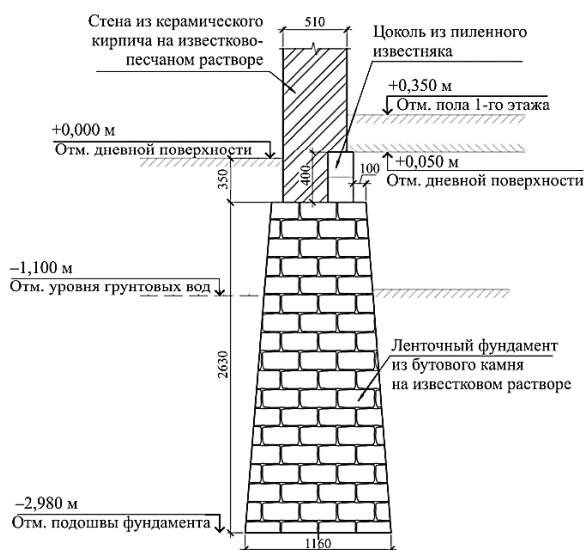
Ленточный фундамент из бутового камня под наружные и внутренние стены здания
